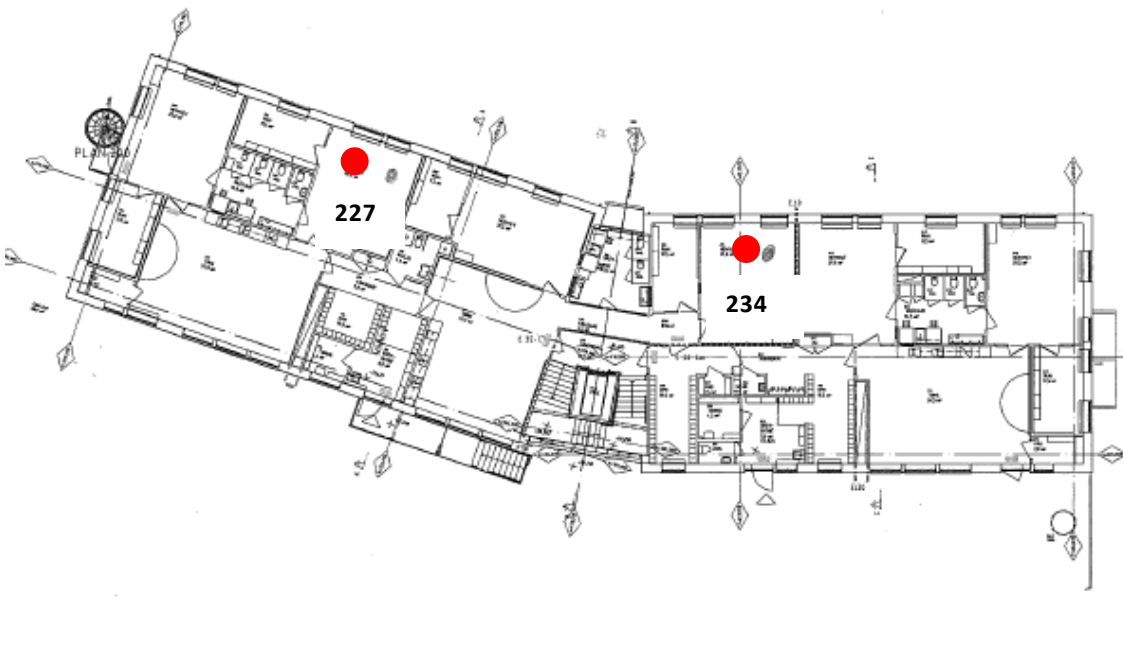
4. Förskolan Hamngården efter ombyggnationen (H2 och H3), planritning, övre plan.
